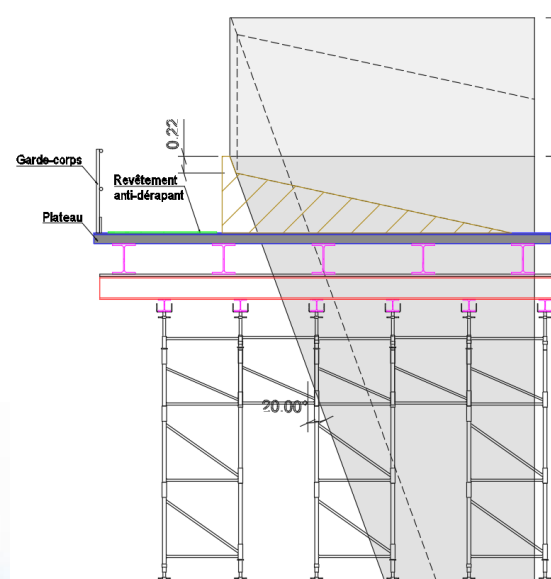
Élévation latérale du coffrage des têtes d'ouvrage
